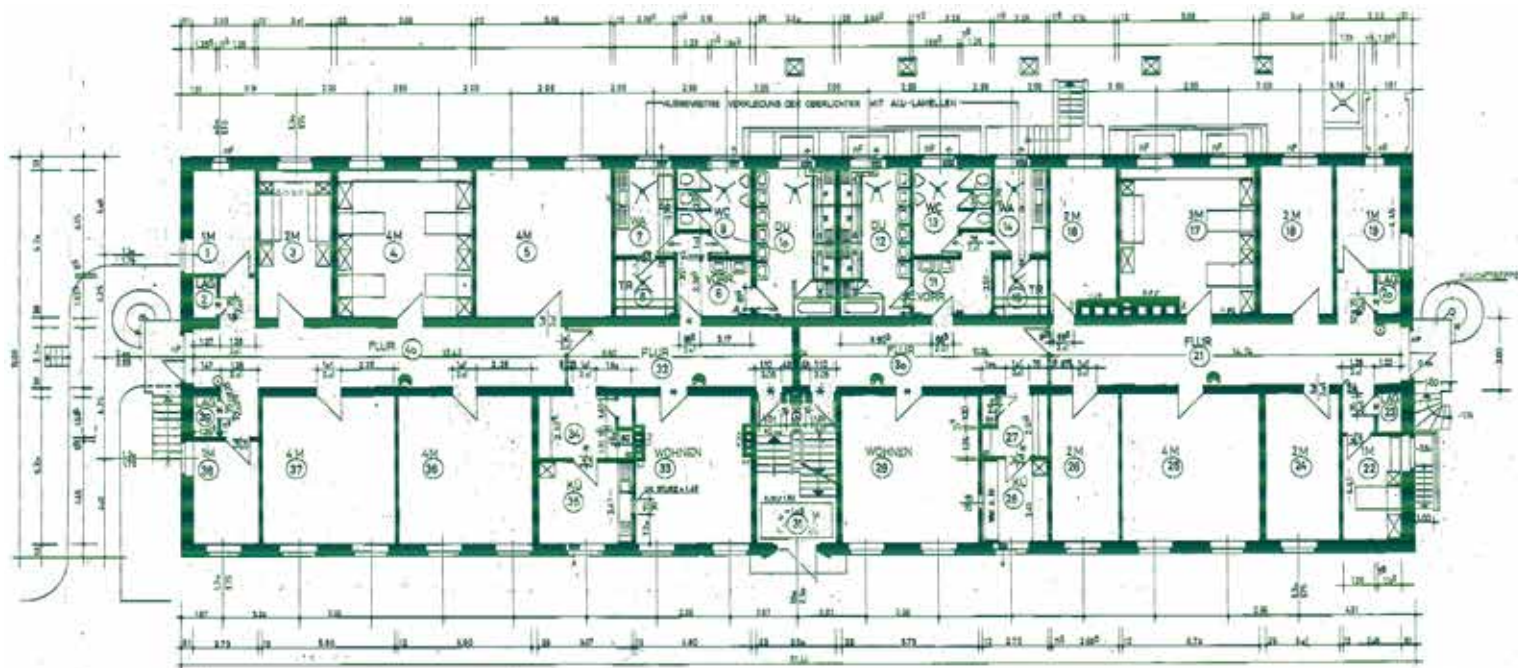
Erdgeschossgrundriss des Mannschaftsgebäudes, BlmA
